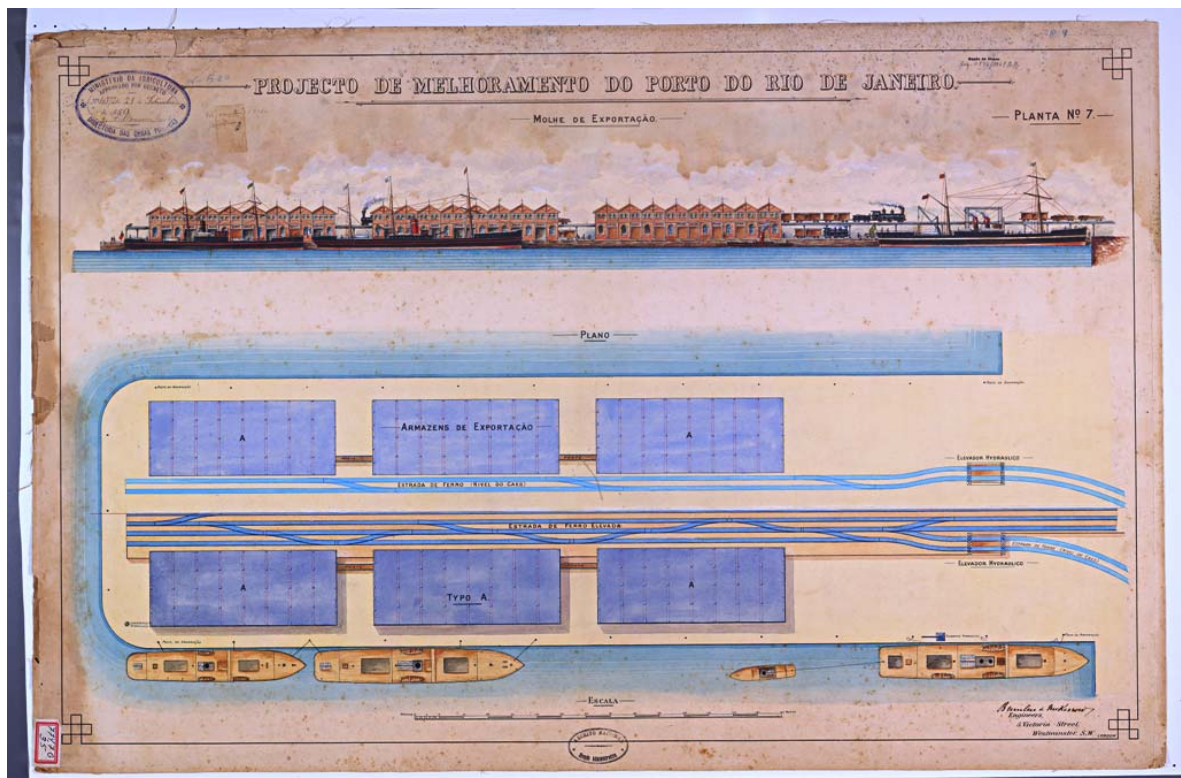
Porto do Rio de Janeiro – Planta Nº. 7
